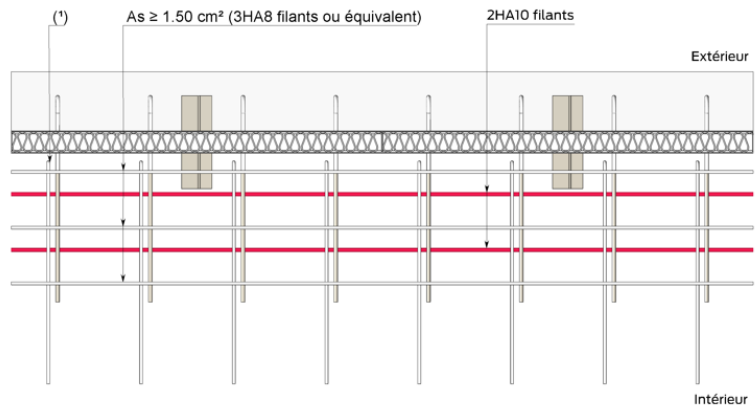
Exemple de ferrailage de plancher (vue en plan)
